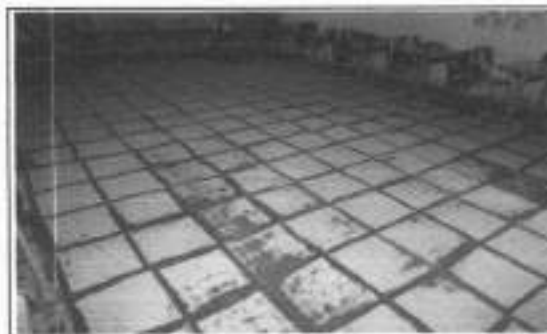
PISO DA SALA DE AULA 01 DANIFICADA
